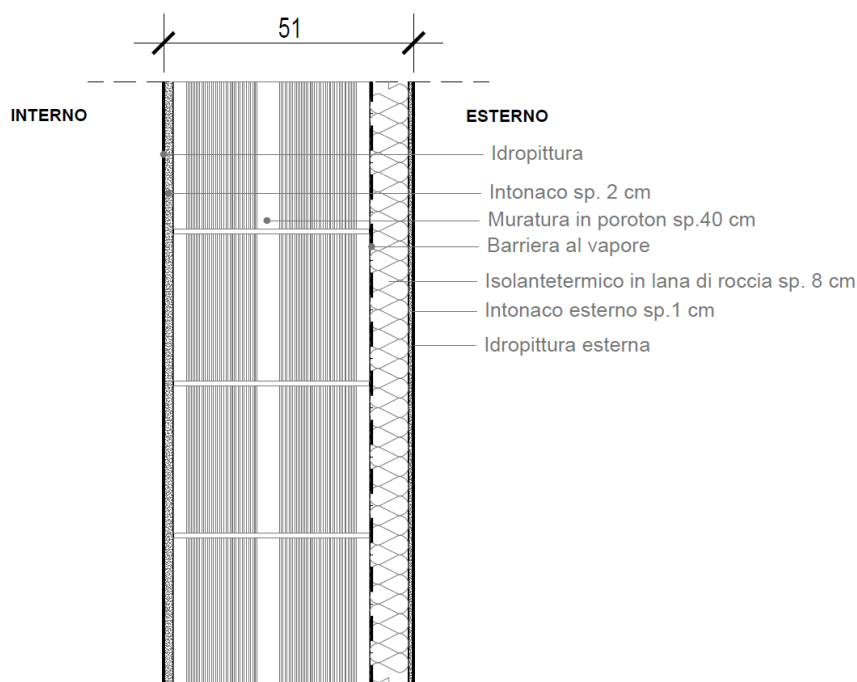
dettaglio della muratura realizzata con cappotto esterno
